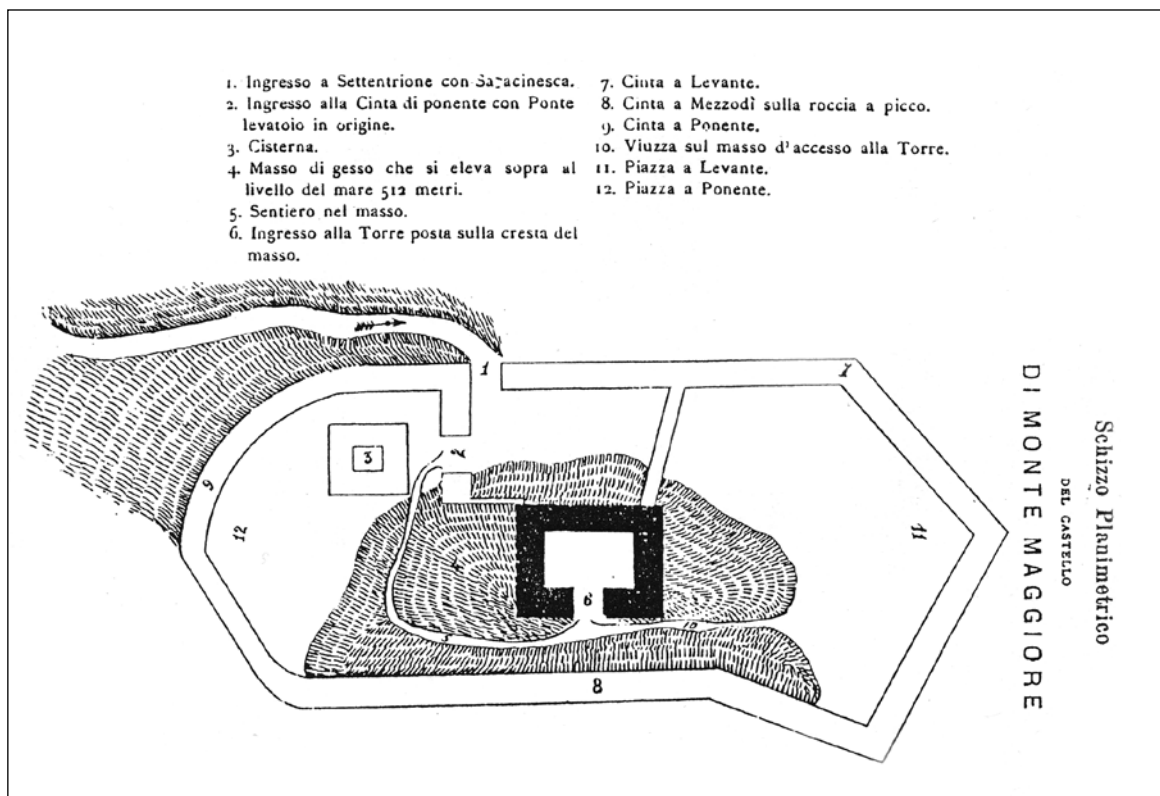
Planimetria della rocca di Monte Mauro (anacronisticamente ancora indicato come «Monte Maggiore») nel 1886 secondo Achille Lega (da LEGA 1886).
